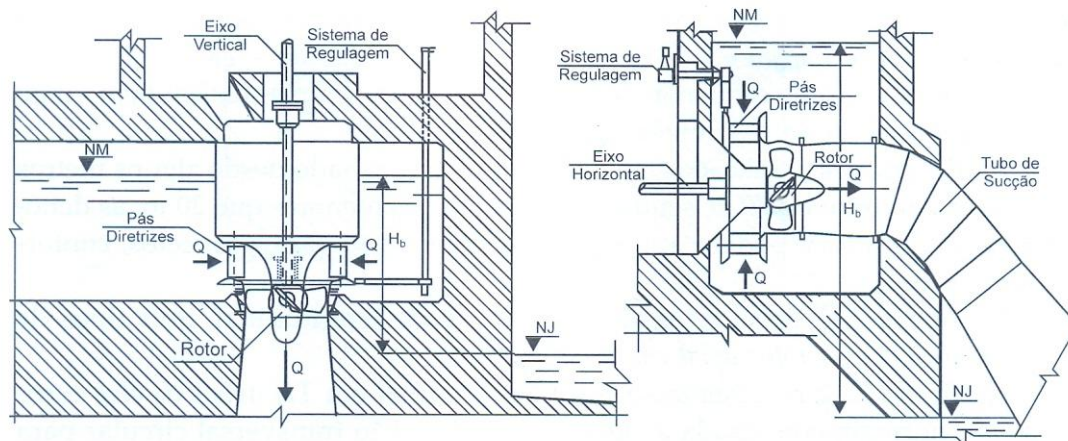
Corte transversal Turbina Hélice em caixa espiral
